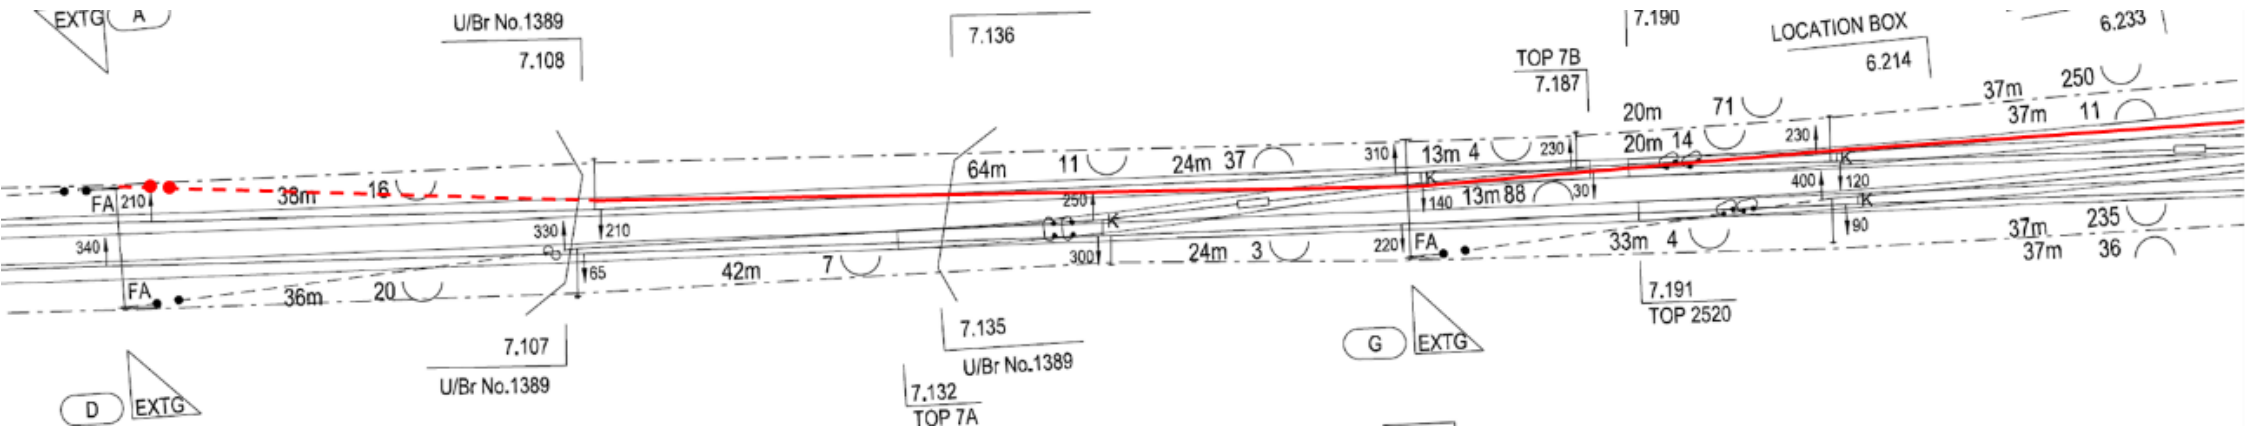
Plano de la instalación de la modificación de la propuesta 3
